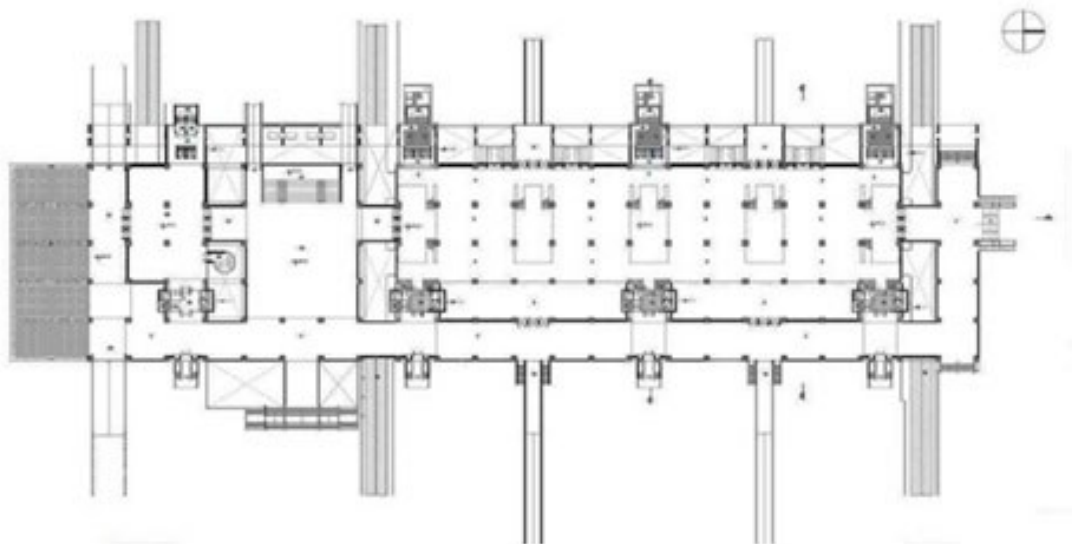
Edificio Centro Cívico-Planta Baja. Fuente: Dirección de Planeamiento y Desarrollo Urbano.
